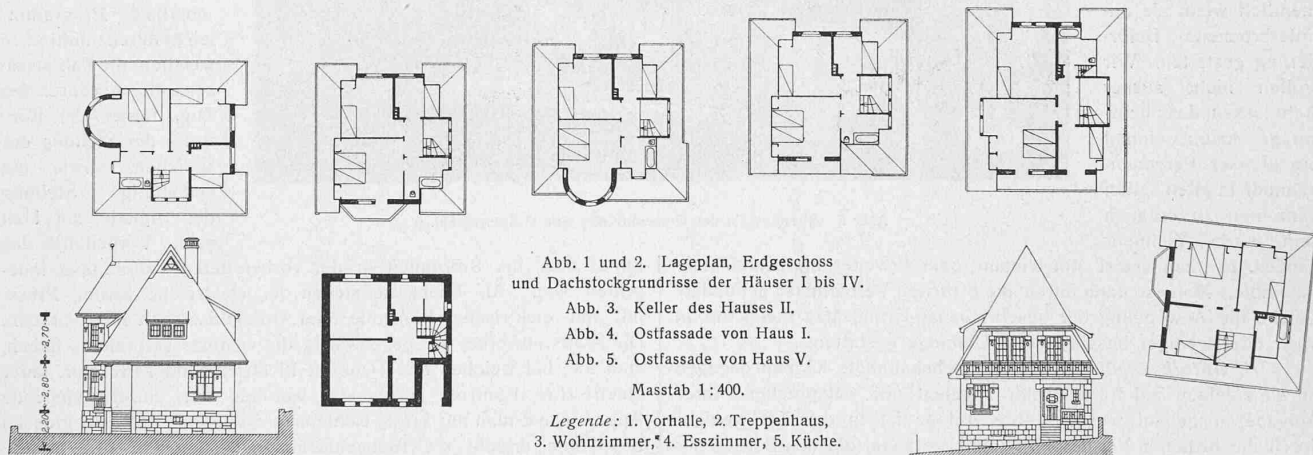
und 2. Lageplan, Erdgeschoss und Dachstockgrundrisse der Häuser I bis IV.
